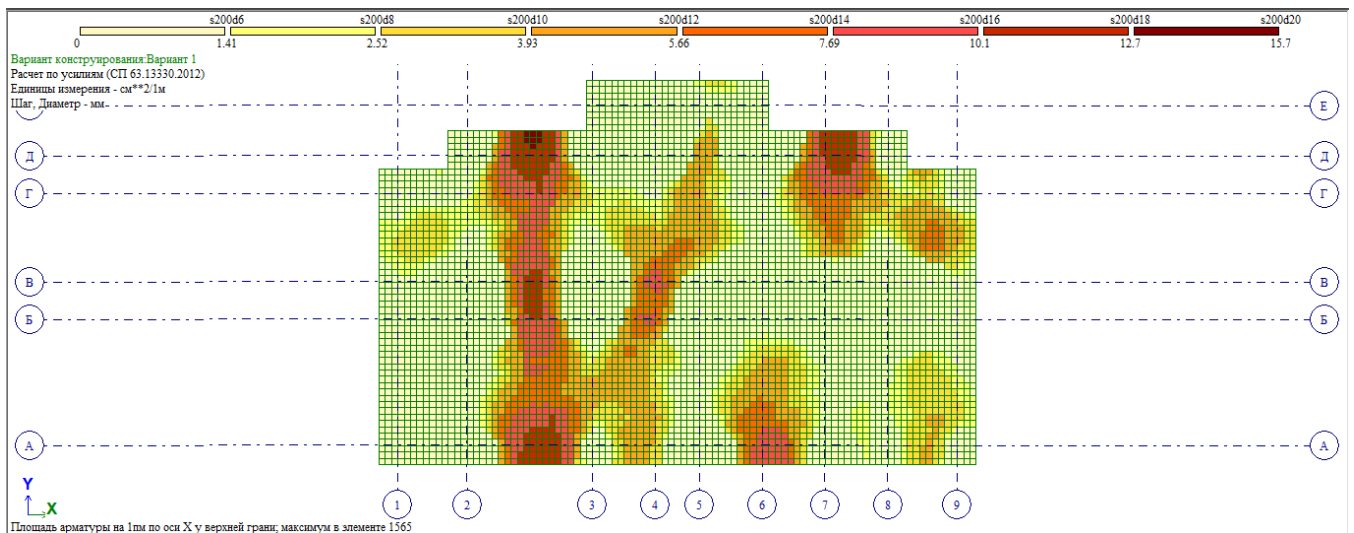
Схема верхнего армирования фундаментной плиты по оси X
